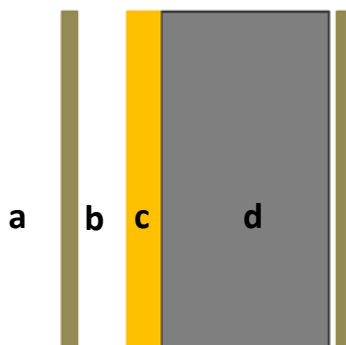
Partes de la fachada ventilada analizada. a. Hoja exterior, b. cámara de aire, c. aislamiento y d. hoja interior
